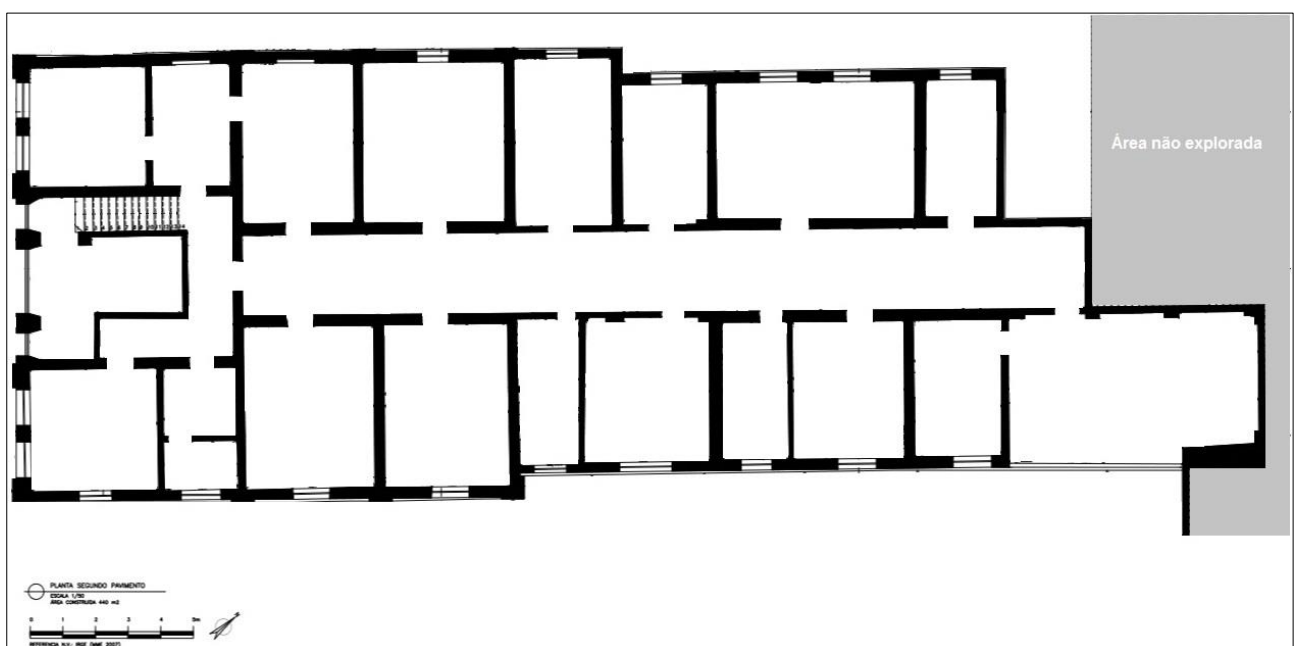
Planta baixa nº 4: segundo pavimento, momento posterior à implantação do HNPI.
